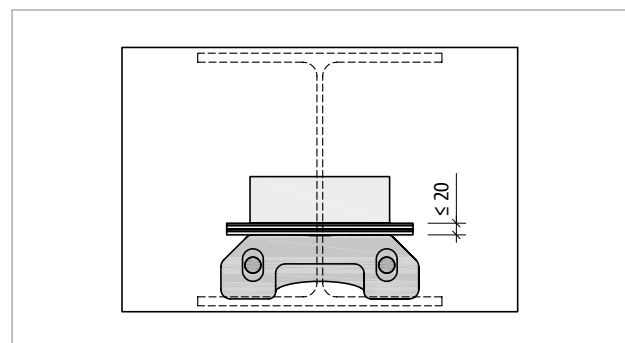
Schöck Isokorb® RT type SQ: Correcte inbouw met gebruik van boormallen zorgt ervoor dat de vereiste inbouwnauwkeurigheid kan worden gegarandeerd.
